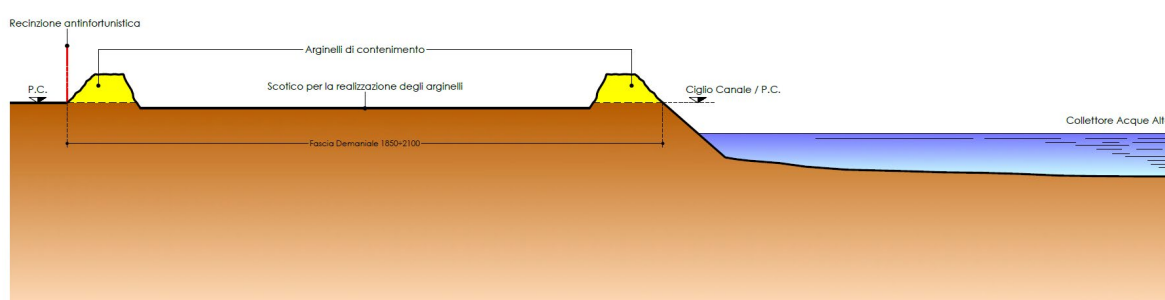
Sezione trasversale tipo dell'area di contenimento.
